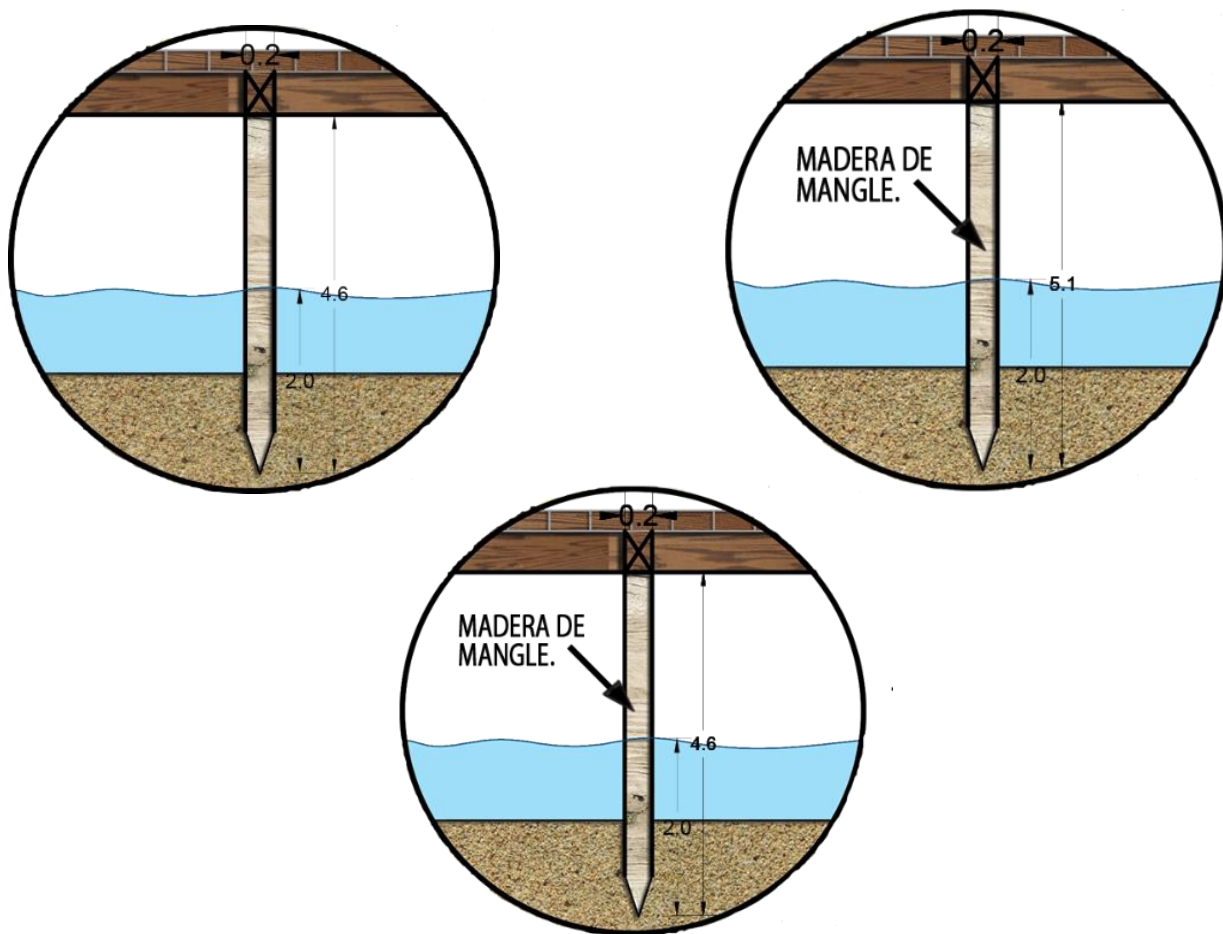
Detalle pilotes de los proyectos Fuente: Elaboración propia
